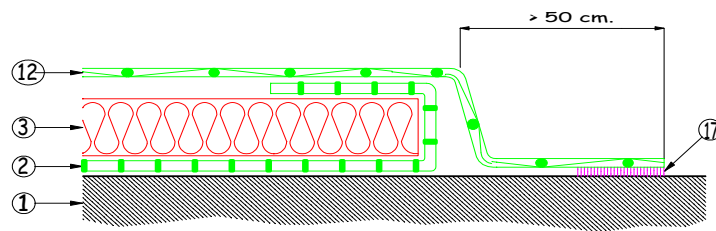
Fermeture provisoire de chantier en travaux neufs
